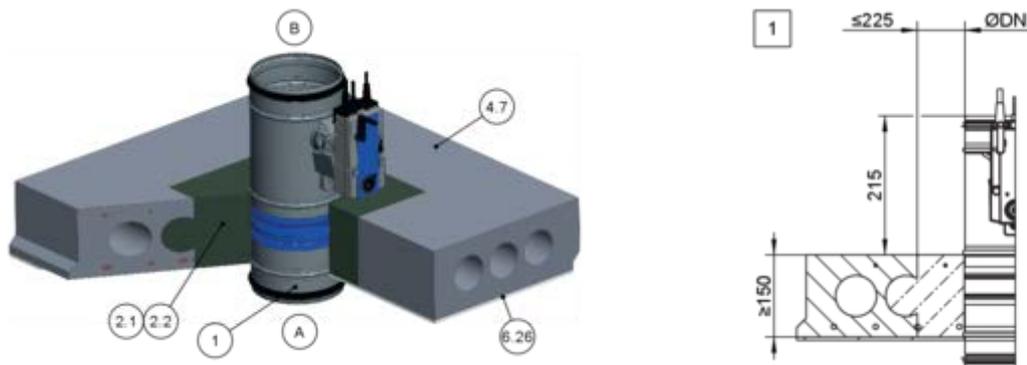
Montage au mortier dans un plafond en dalles de béton alvéolaires, vertical (s'applique également à la disposition suspendue)
